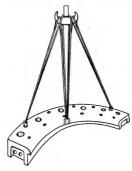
Схема строповки несимметричной сегментной детали.
